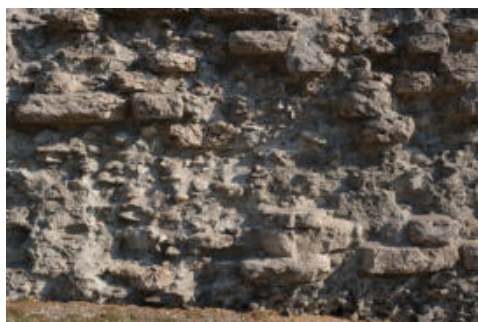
Lato sud della cinta muraria (foto di Lorenzo Appolonia, 2022)
